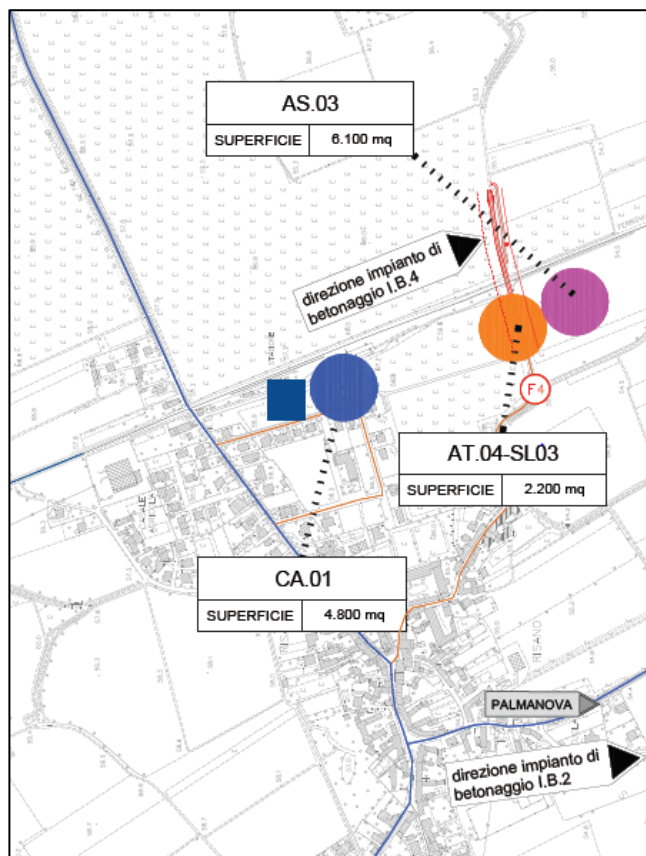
Aree di cantiere e viabilità di accesso 2/2
